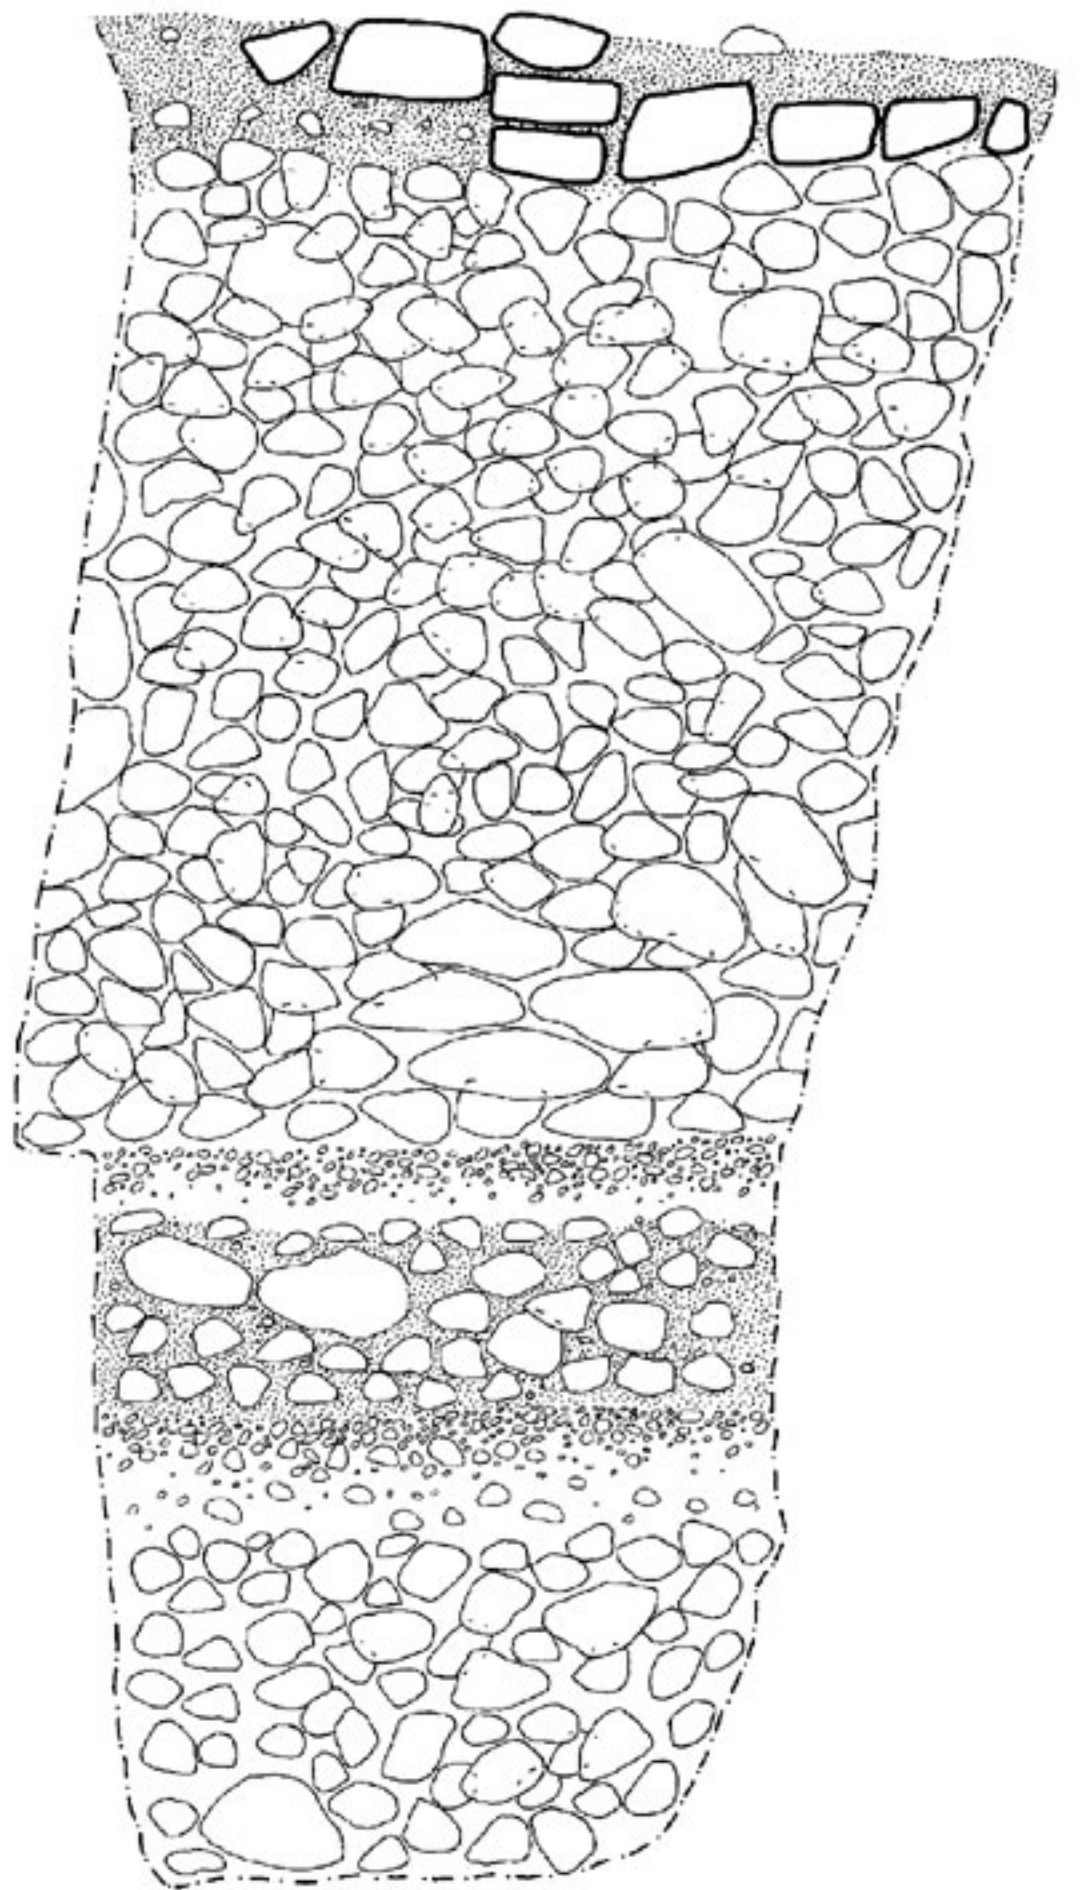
PN 47 C-2-5 elevación, perfil y planta de subestructura.
